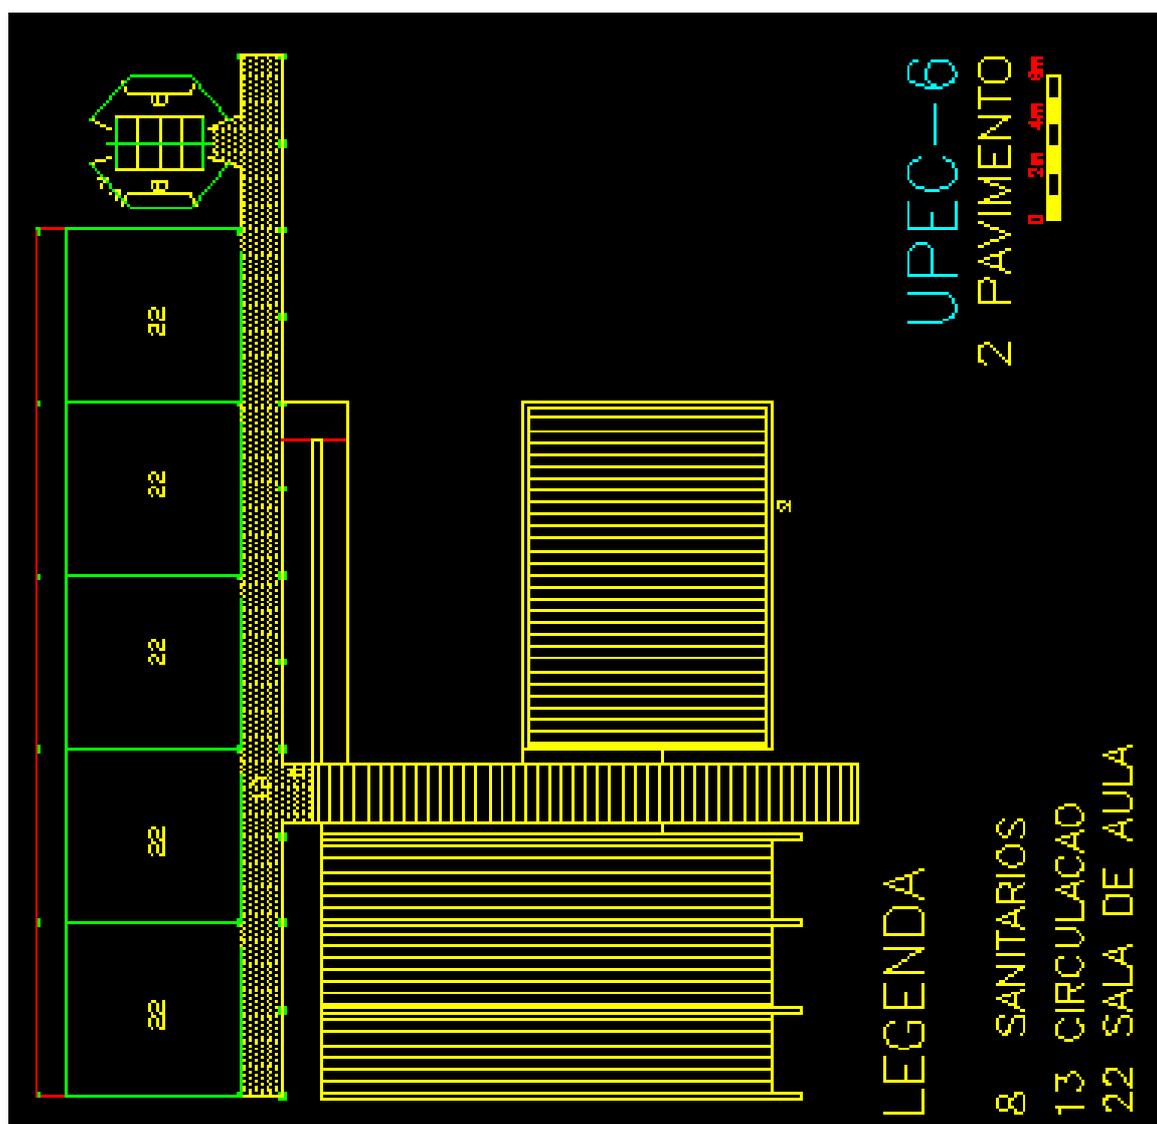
UPEC-6 / PLANTA 2º NÍVEL
